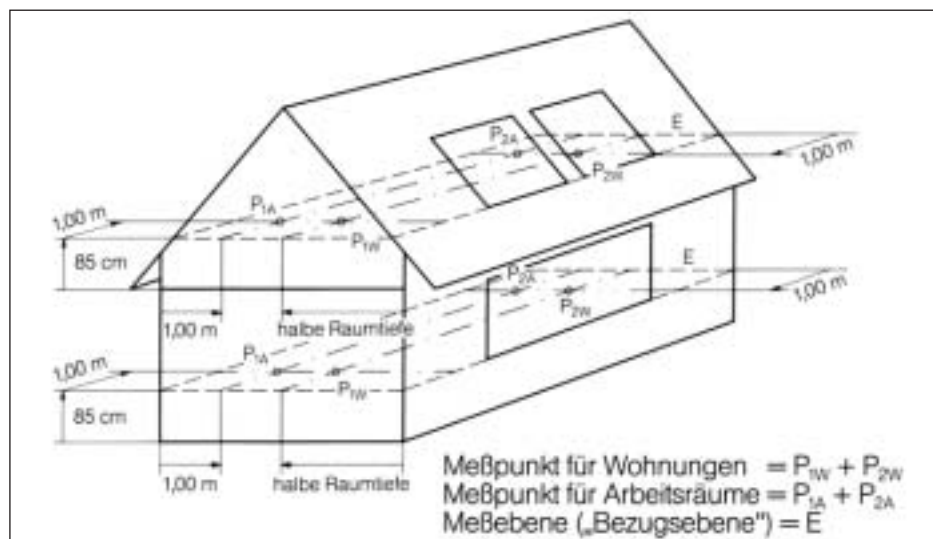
Meßpunkte in Senkrecht- und in Räumen unter dem geneigten Dach
